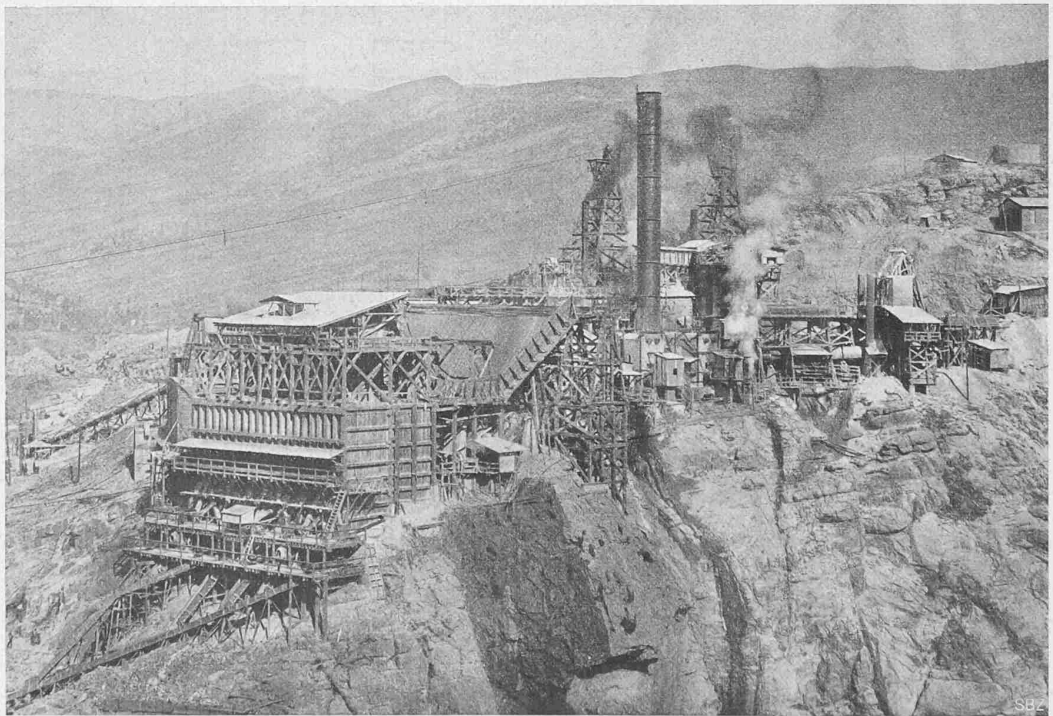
Gesamt-Installation zur Betonbereitung für den Bau der San Antonio-Staumauer (26. September 1913). Steinbruch hinter der Zementfabrik, Steinbrecher und Sortieranlage in der Mitte, rechts Zementfabrik, links Zement- und Kies-Sand-Silogegebäude (noch unverschalt), darunter Batterie von Beton-Mischern mit Entleerung in die Beton-Förderrinnen nach den Arbeitsplätzen in der Baugrube.
